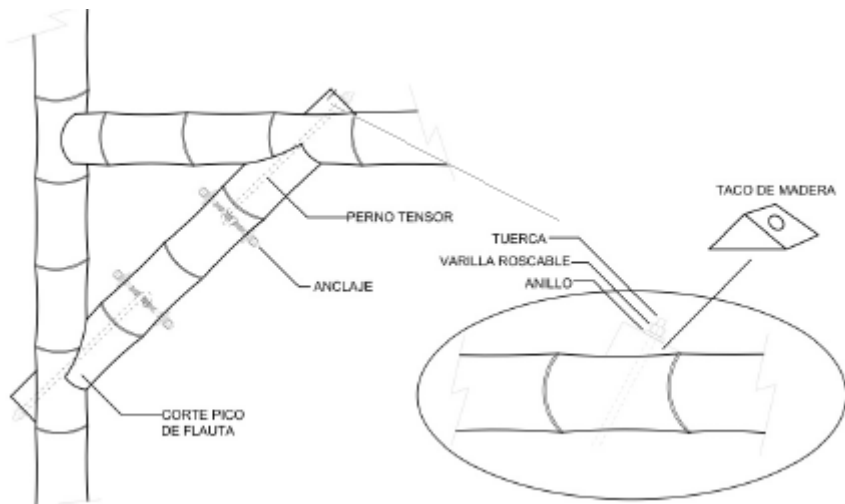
Detalle de armado de unión en Diagonal mediante el corte pico de flauta
